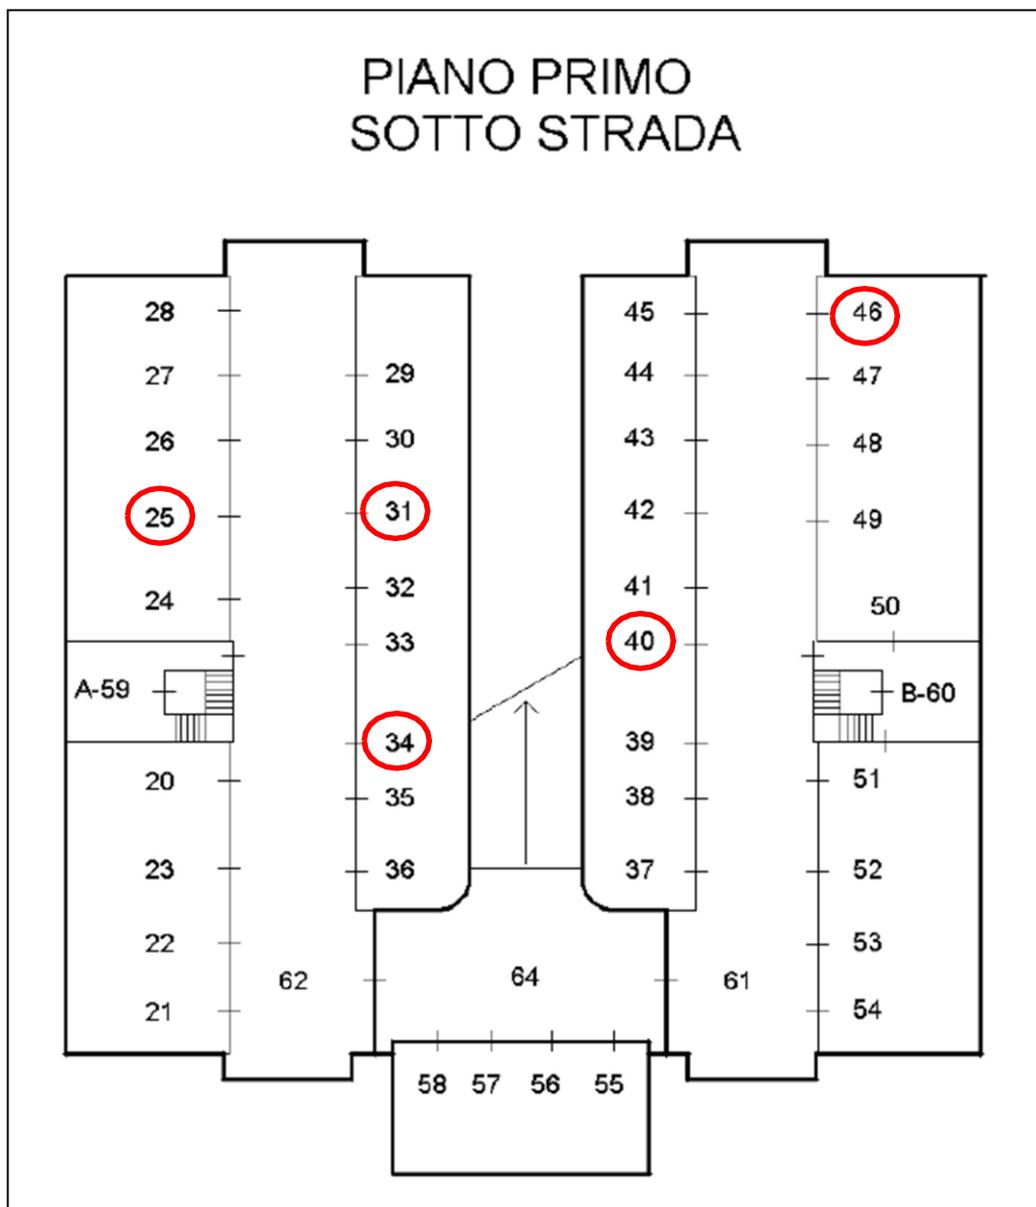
elaborato planimetrico del piano primo sottostrada (interrato) con indicazione delle unità oggetto di valutazione
